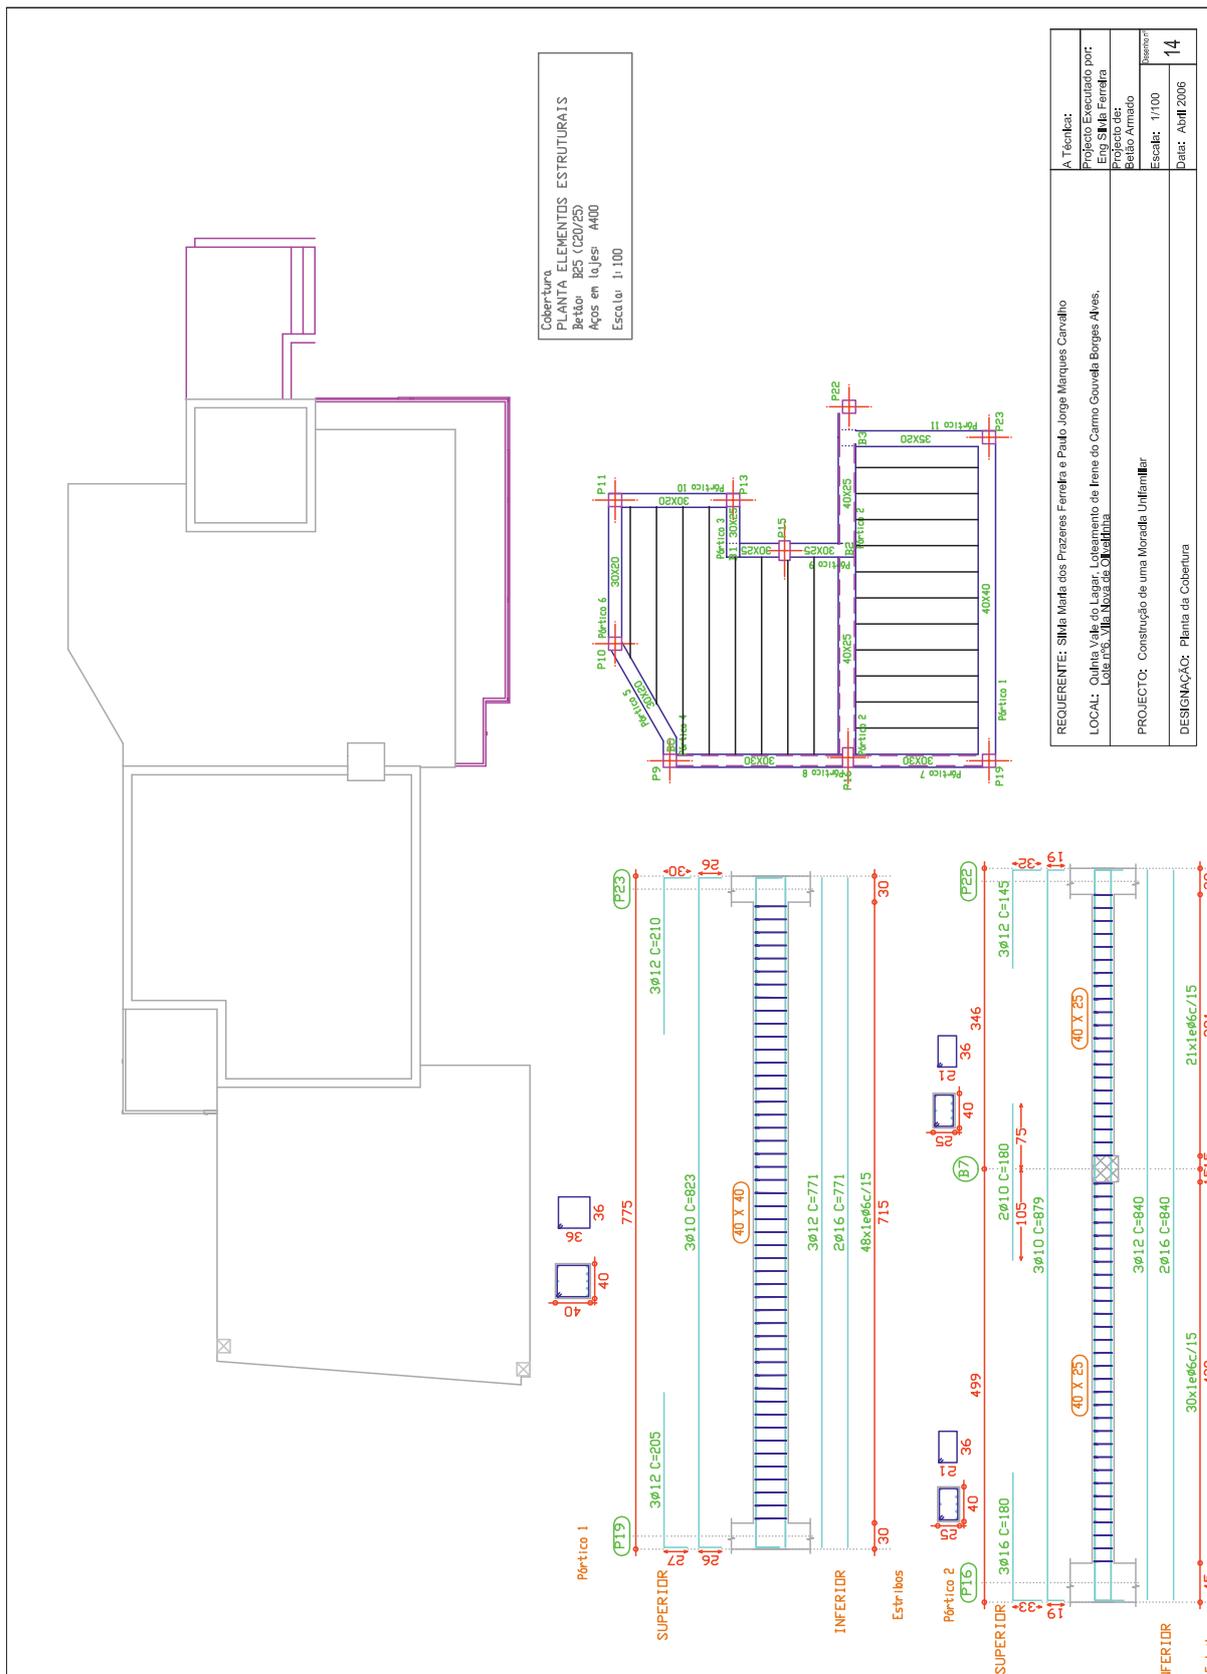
Planta de arquitetura/estrutural de cobertura e pormenores da solução em BA
